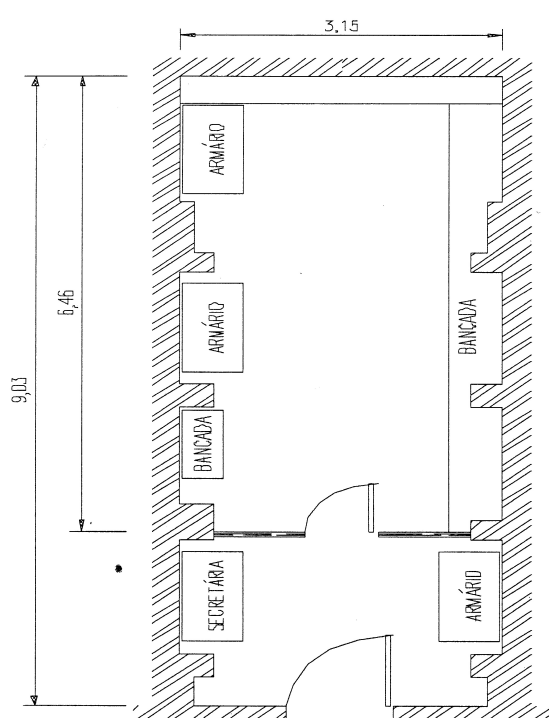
Planta da primeira instalação do LCAM/LNEC
